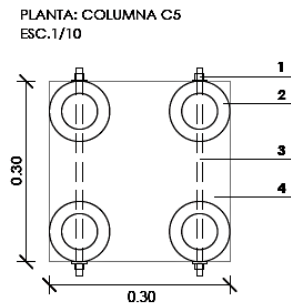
Planta de columna cuadrada de bambú. Fuente: Elaboración propia.
